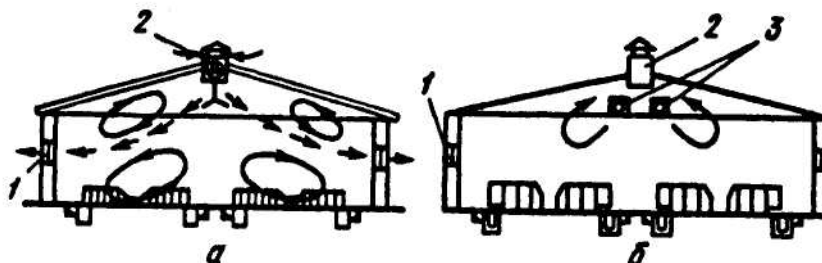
Вентиляция животноводческих помещений по схеме с избыточным давлением и вентиляторами, расположенными на крыше: а - теплый период года; б - холодный период; 1 - оконные проемы; 2 - вытяжные шахты; 3 - приточный воздуховод
